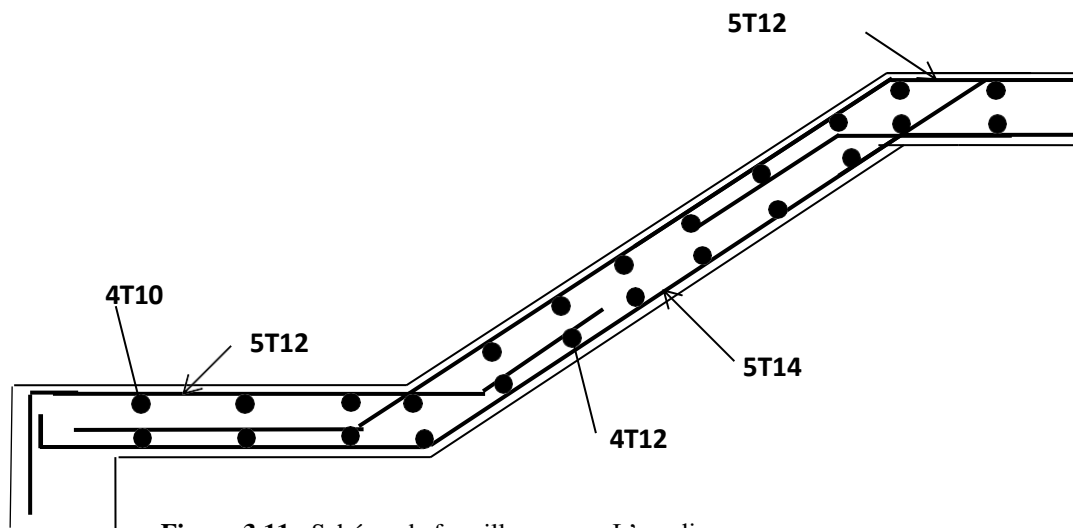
Schéma de ferrailage pour L'escaliers.
